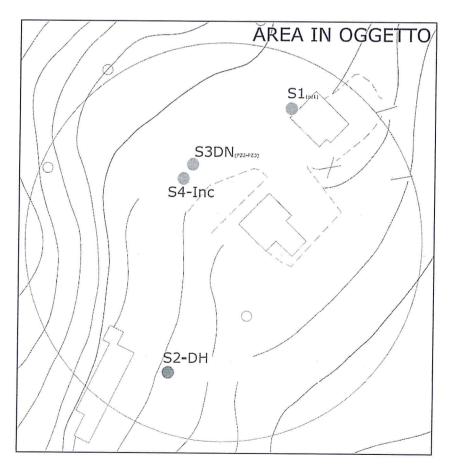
Planimetria con ubicazione delle verticali di indagine
